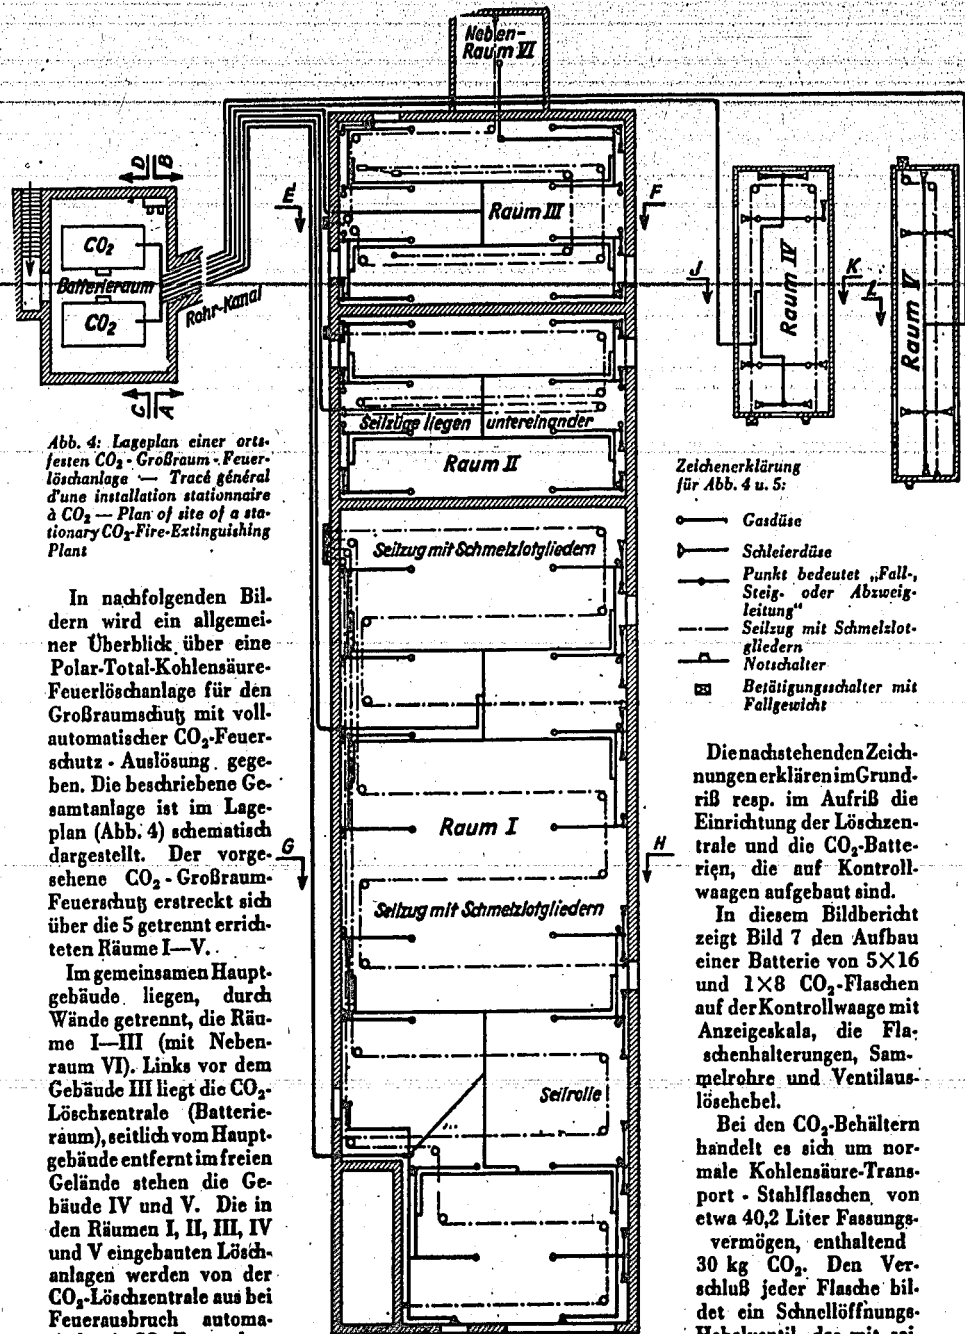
Lageplan einer ortsfesten CO<sub>2</sub>-Großraum-Feuerlöchanlage — Tracé général d'une installation stationnaire à CO<sub>2</sub> — Plan of site of a stationary CO<sub>2</sub>-Fire-Extinguishing Plant
